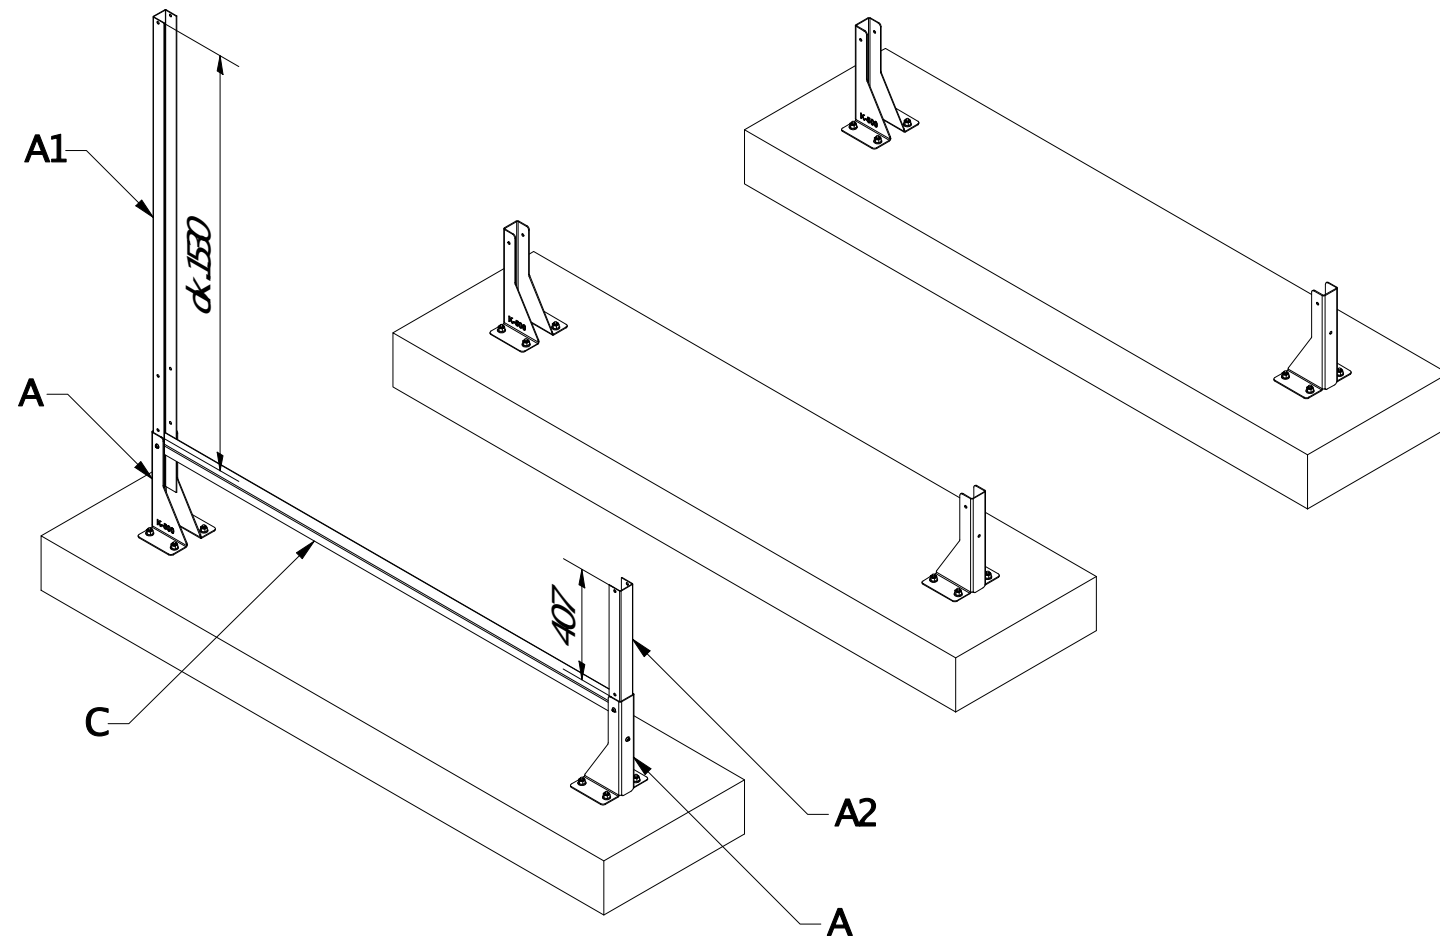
Montáž betonového základu (A) na vylitou betonovou patku
